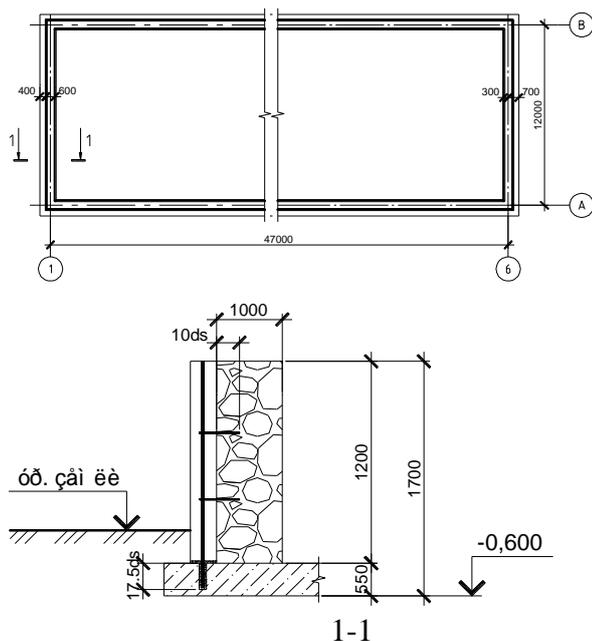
Схема ленточного фундамента реконструируемого жилого дома
